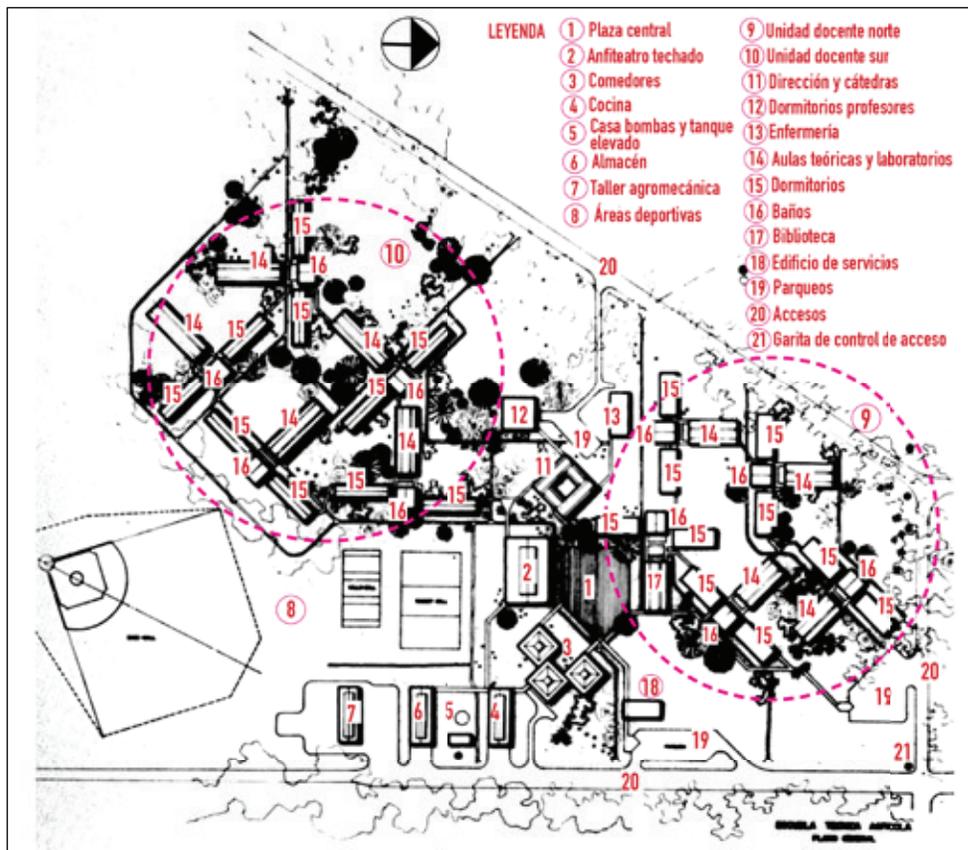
Plano de Plan General, “Escuela Técnica Agraria” (según rótulo que aparece en el plano). Fuente: Plano editado por los autores a partir del aportado por Khristian Zecchin.
